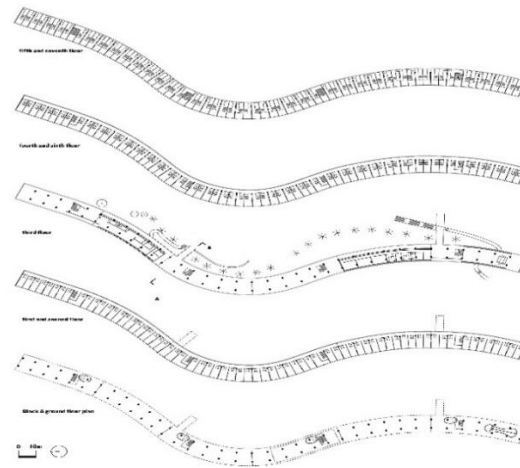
Conjunto Pedregulho: Planta dos pavimentos no bloco A. Fonte: The Architectural Review
